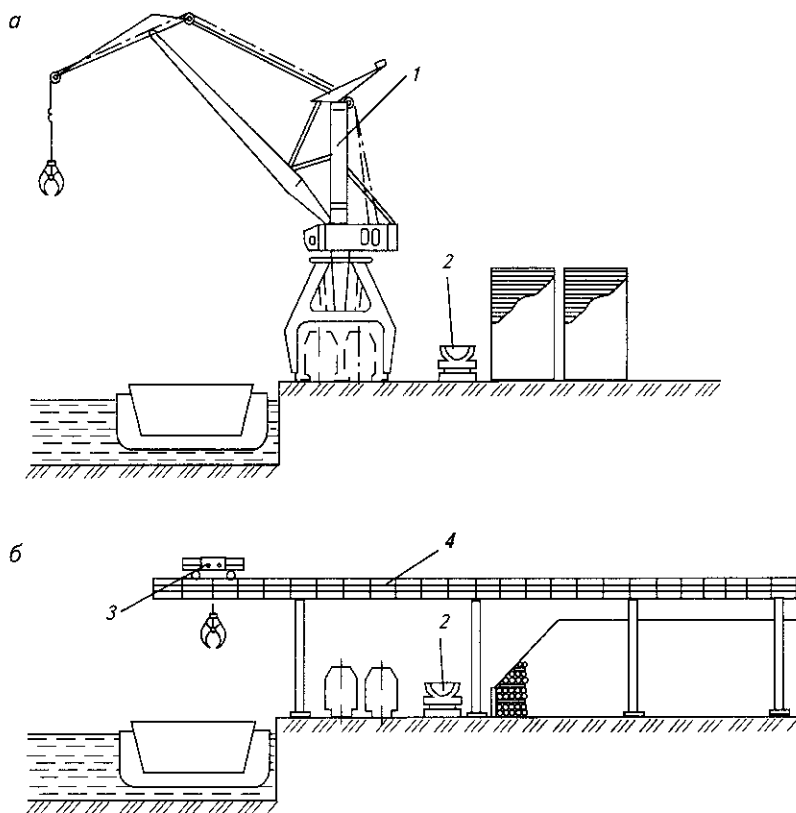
11 Выгрузка круглых лесоматериалов из судов портальными и мостовыми кранами на причале:
